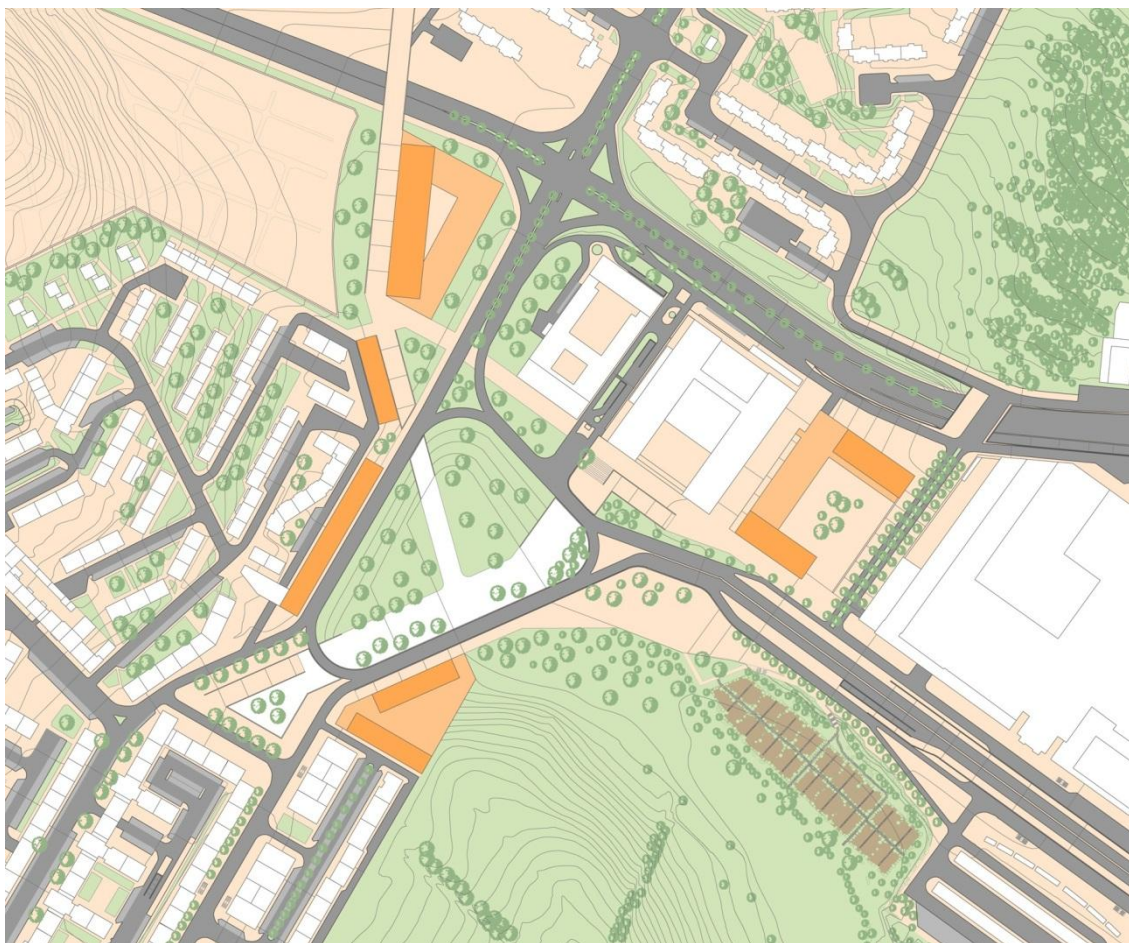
| Fase 2 . Planta da Estrutura Edificada
